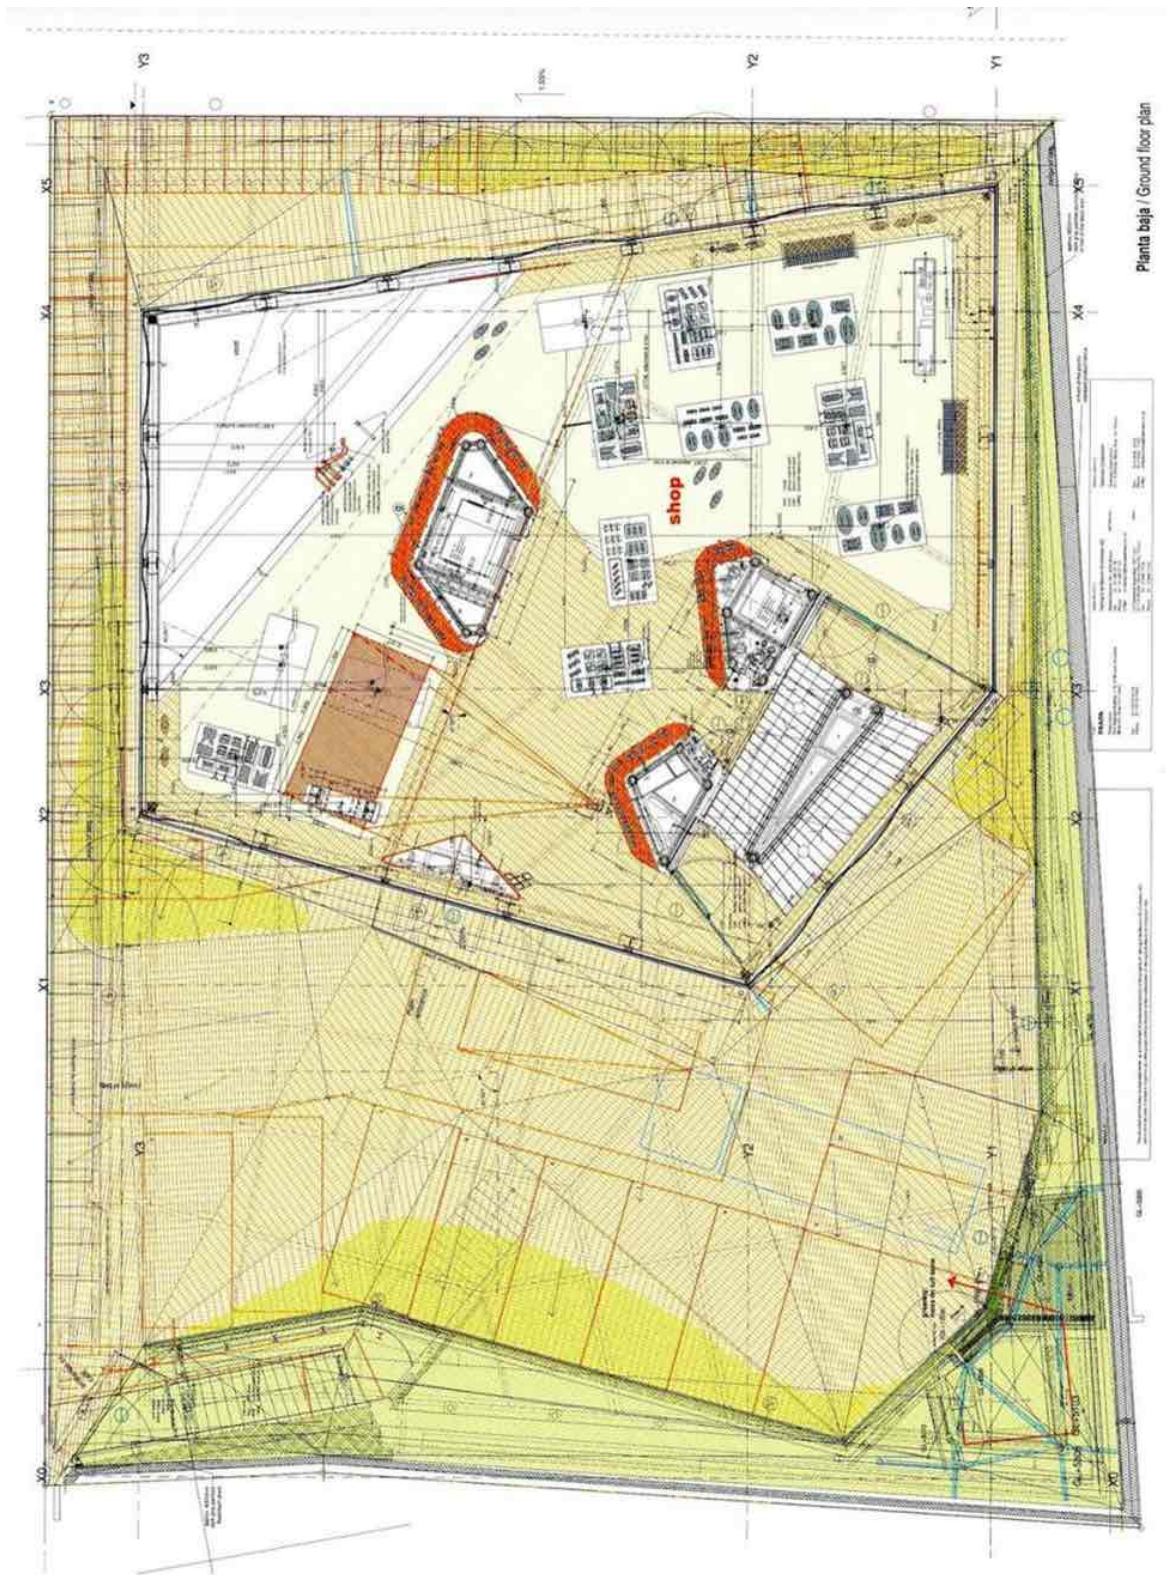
Pianta del piano terreno alla scala d'informazione 1:20 (non direttamente misurabile sull'immagine a stampa).
